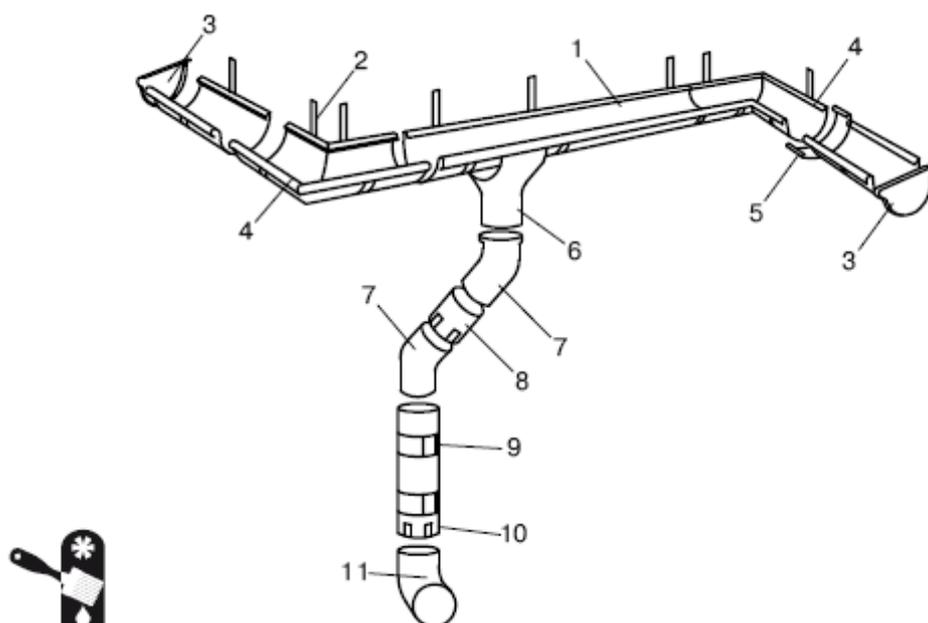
Детали водосточной системы: 1 – полукруглый желоб; 2 – крюк; 3 – заглушка желоба; 4 – угол желоба; 5 – соединитель желоба; 6 – воронка желоба; 7 – колено трубы; 8 – круглая соединительная труба; 9 – кронштейн; 10 – круглая труба; 11 – колено стока
